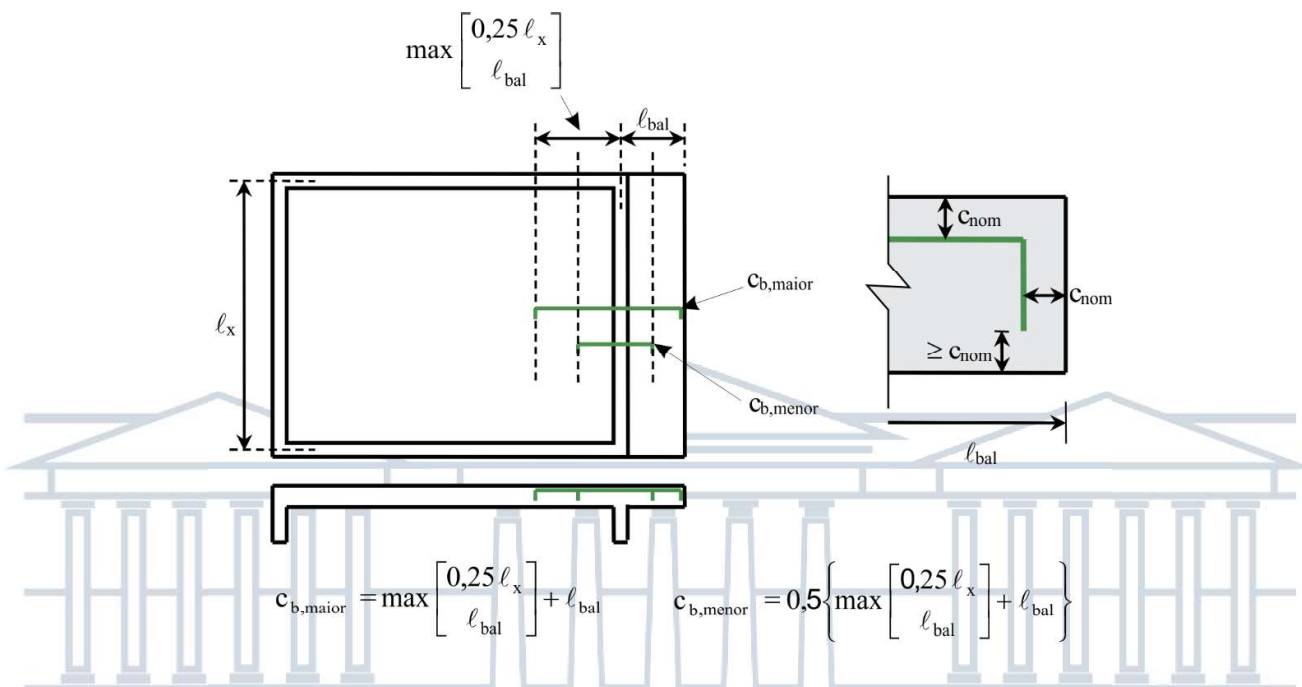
Comprimento de barras alternadas de lajes em balanço – armadura negativa
